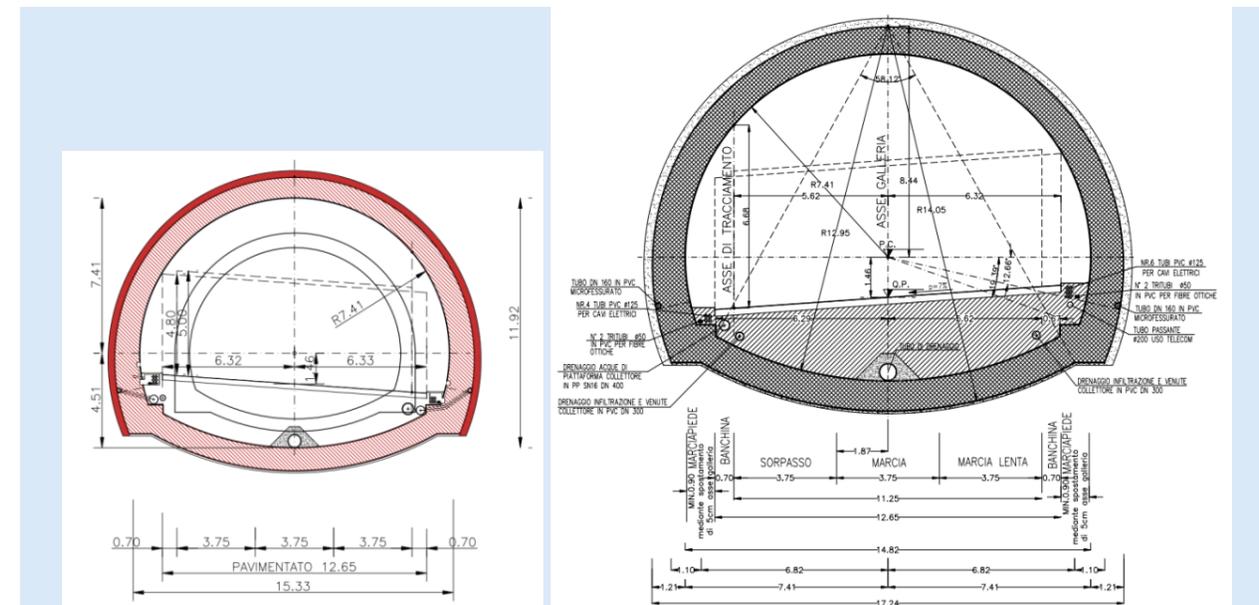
sezione tipo galleria naturale carreggiata nord nel PE 2008
